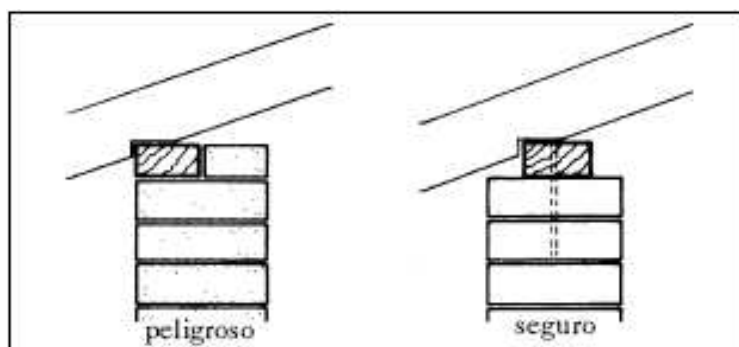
Emplazamiento del encadenado sobre el muro.
